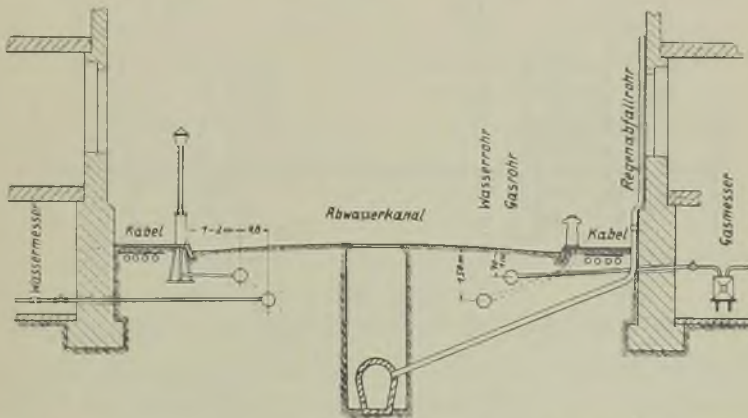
Schnittzeichnung einer Straße mit sämtlichen Rohrleitungen.
